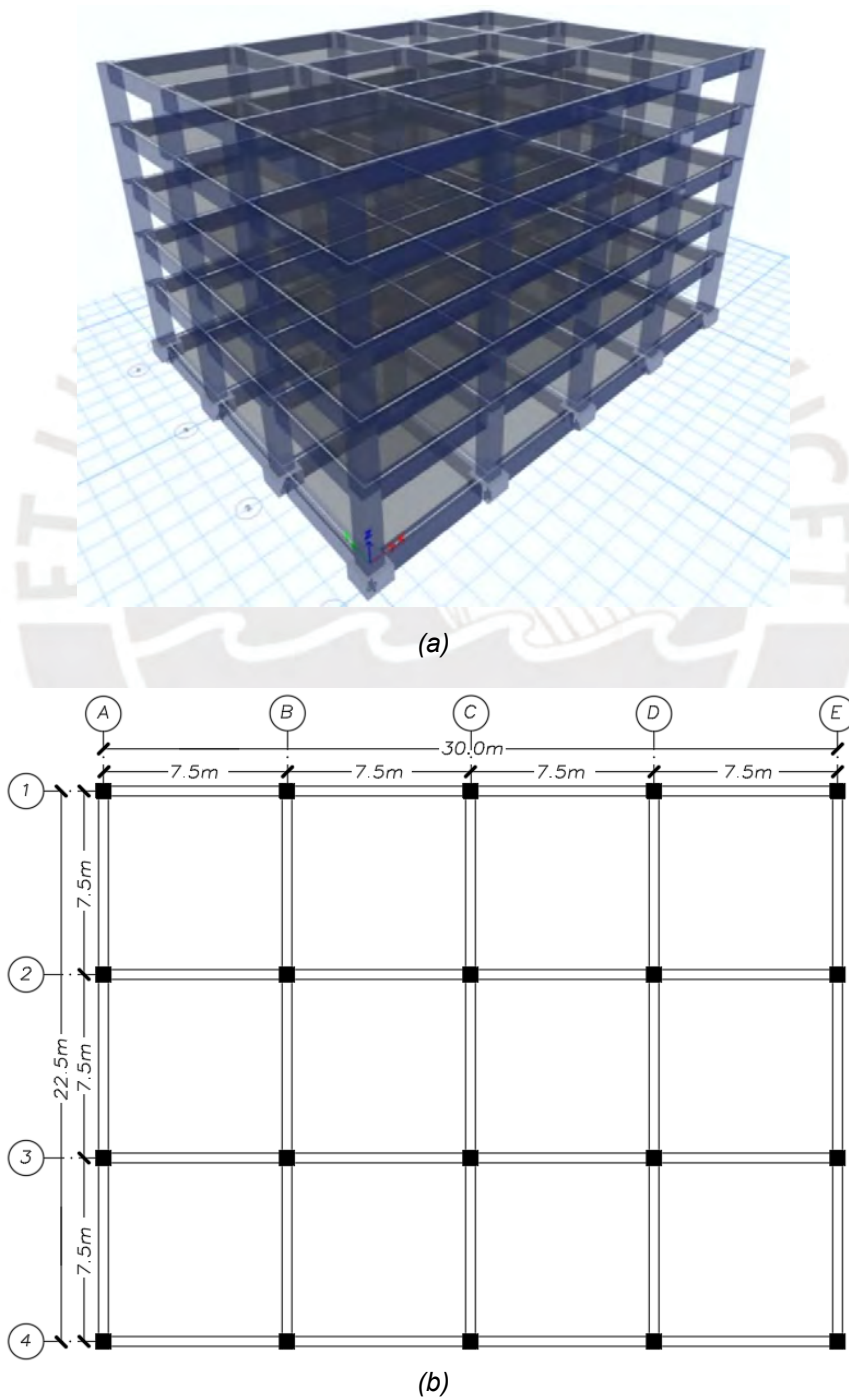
(a) Vista 3D y (b) dimensiones en planta del caso estudiado.
